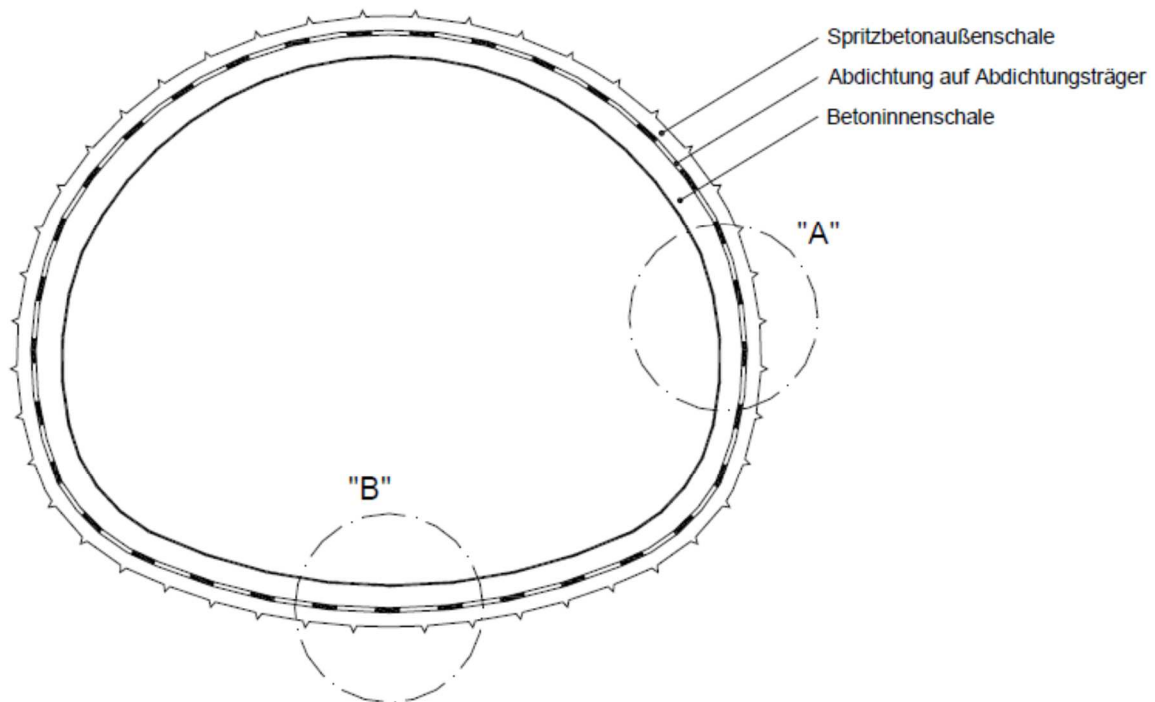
Tunnelquerschnitt mit Spritzbetonaußenschale, Abdichtungsträger und Betoninnenschale<sup>5</sup>
